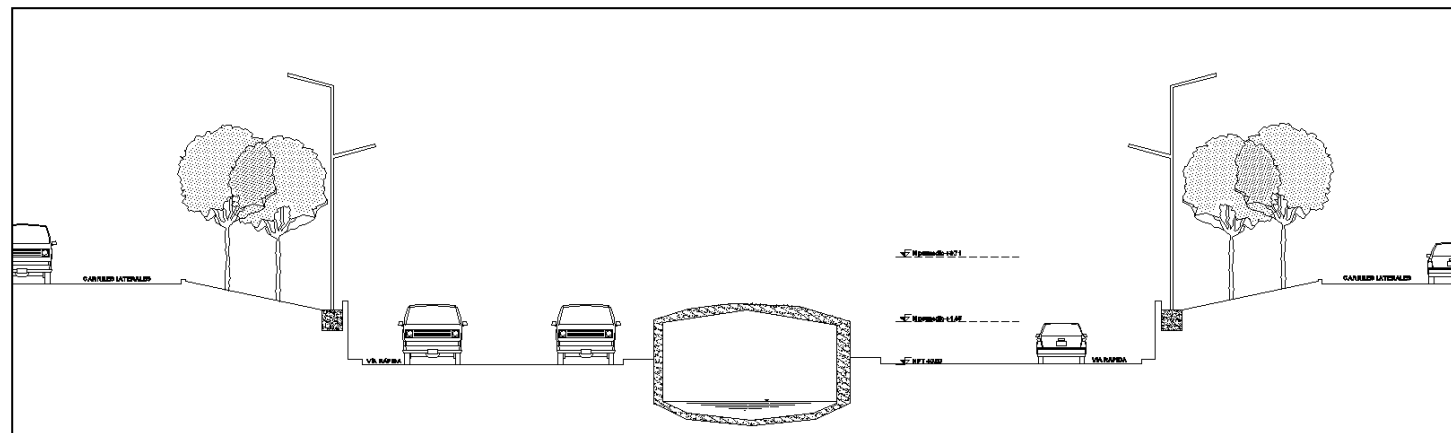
Secciones tipo del Viaducto Río De La Piedad
